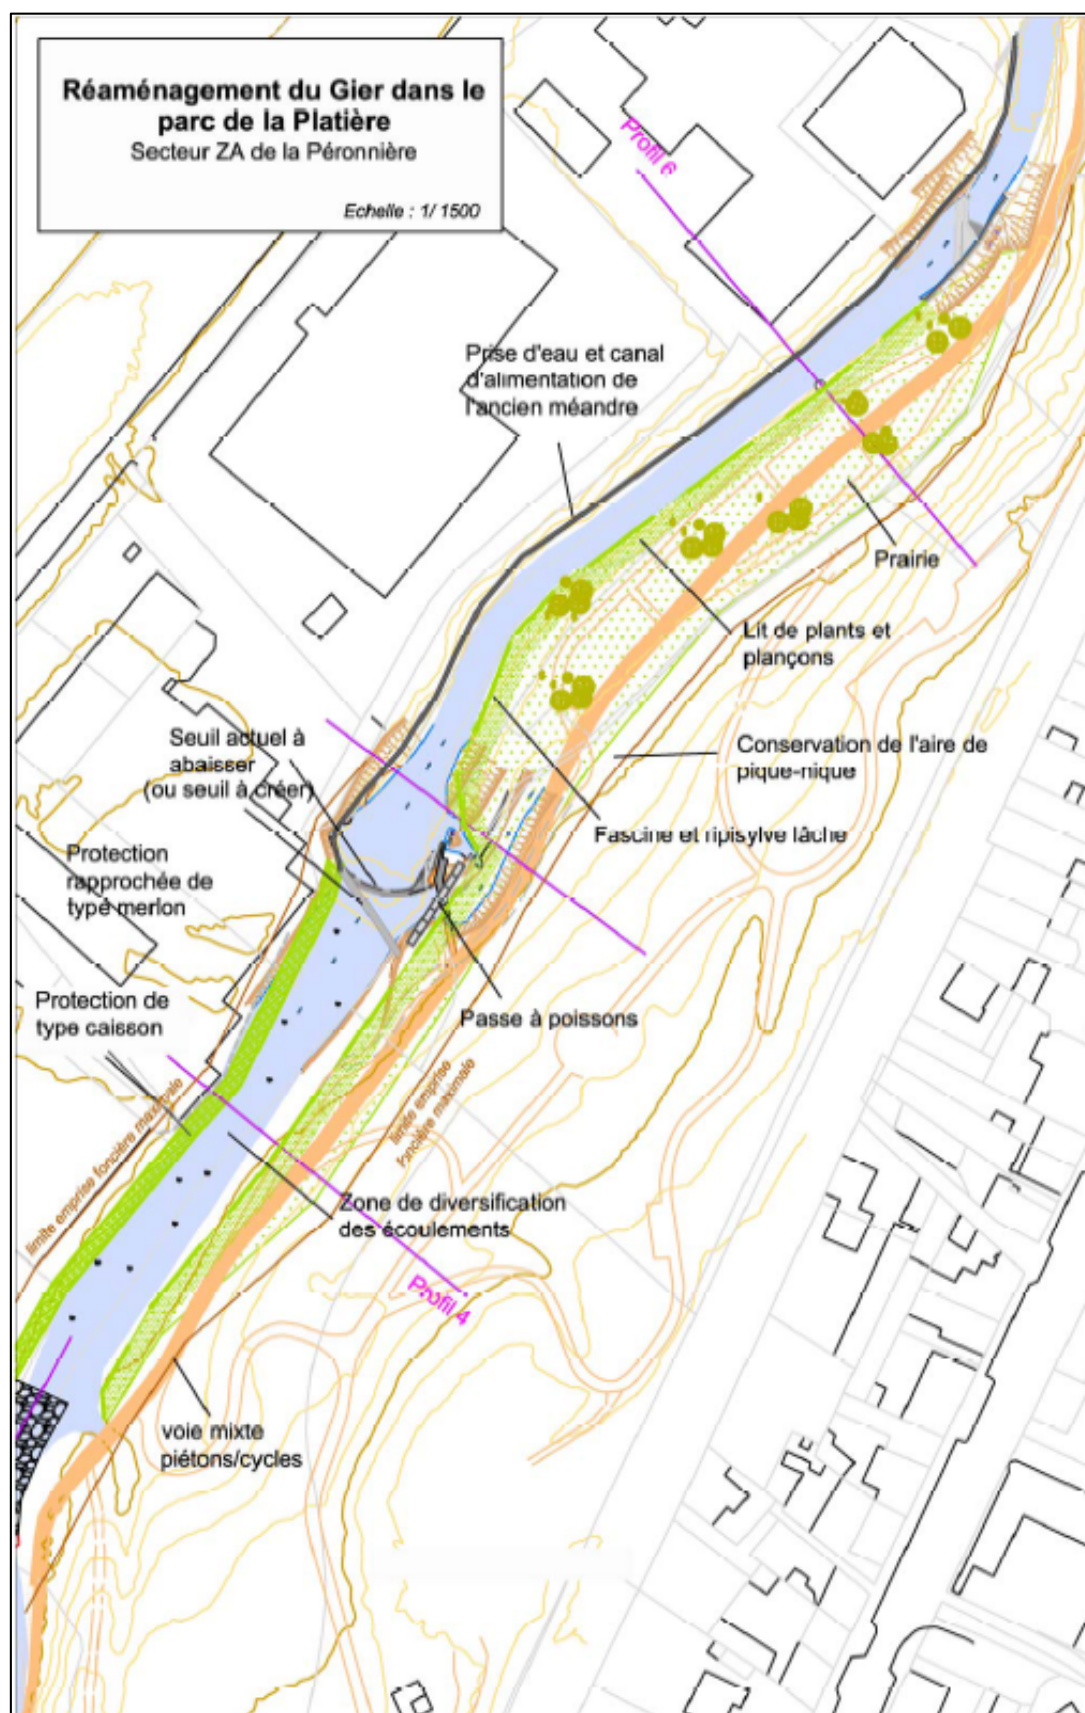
vues en plan des travaux projetés sur le tronçon n° 2
